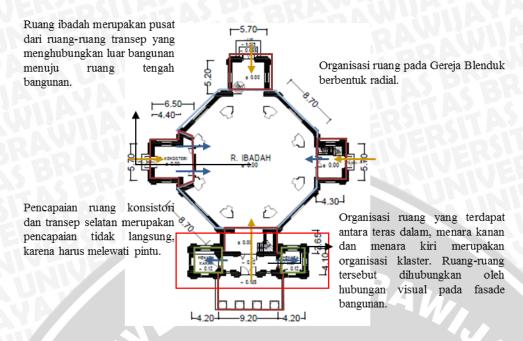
Hubungan ruang lantai 2 Gereja Blenduk
